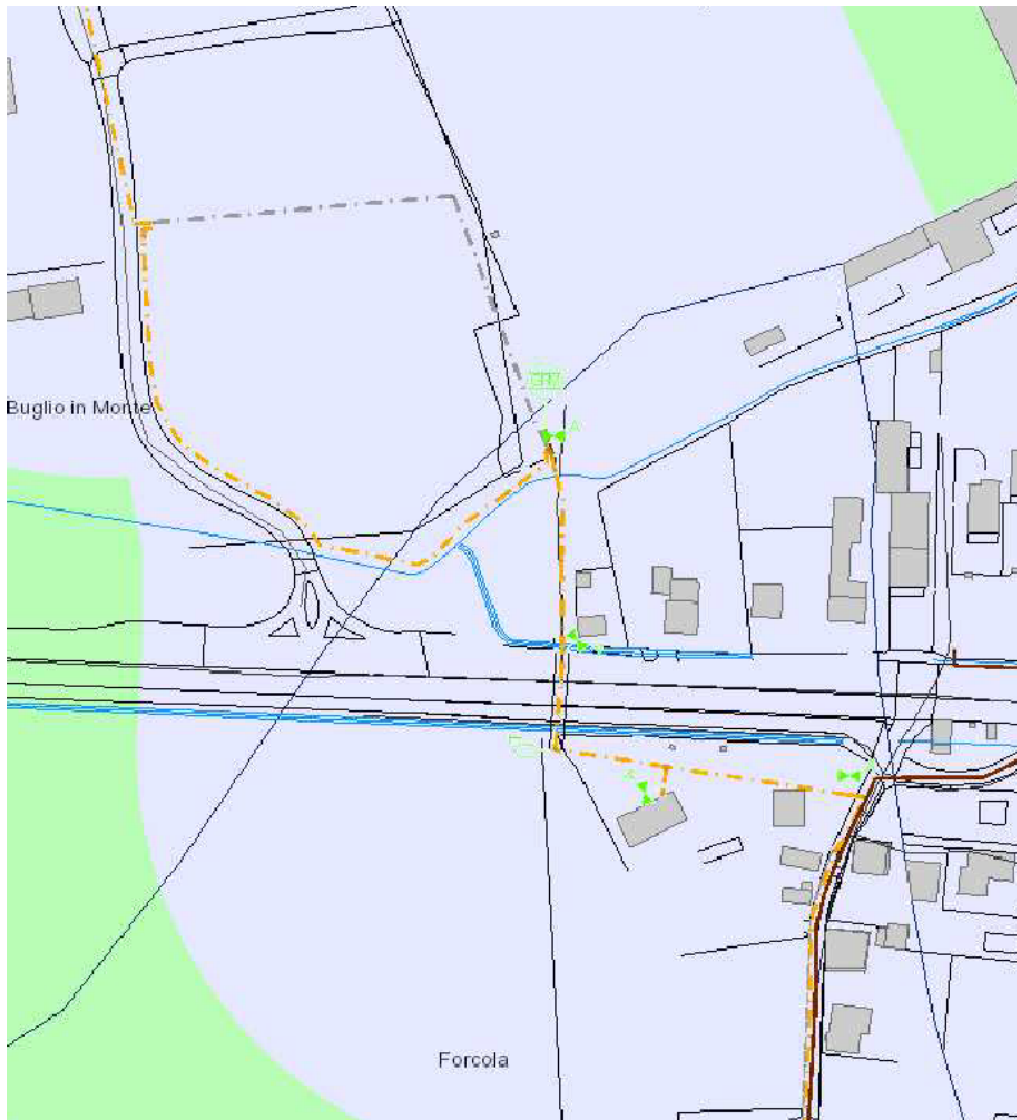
Tracciato rete elettrica inviato dall'Ente
